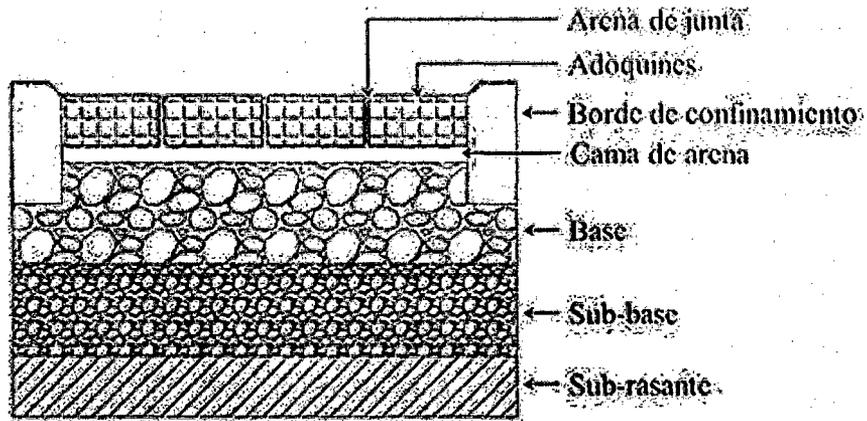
Elementos Estructurales de un pavimento de adoquines (ASCE, 2010)
